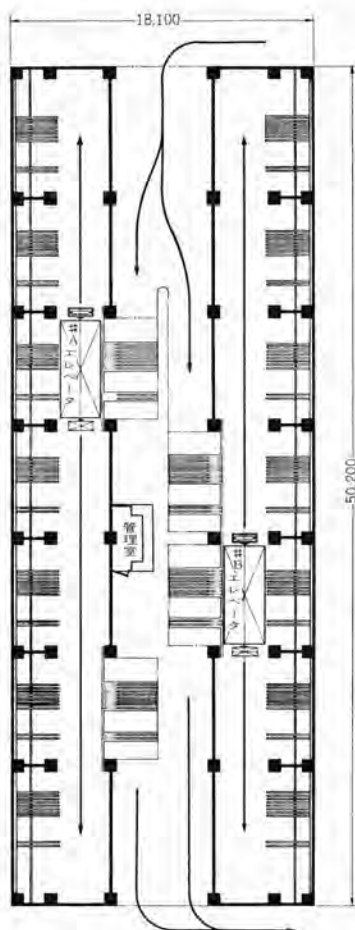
クレーン・エレベータ・フォーク式 1 階平面図
